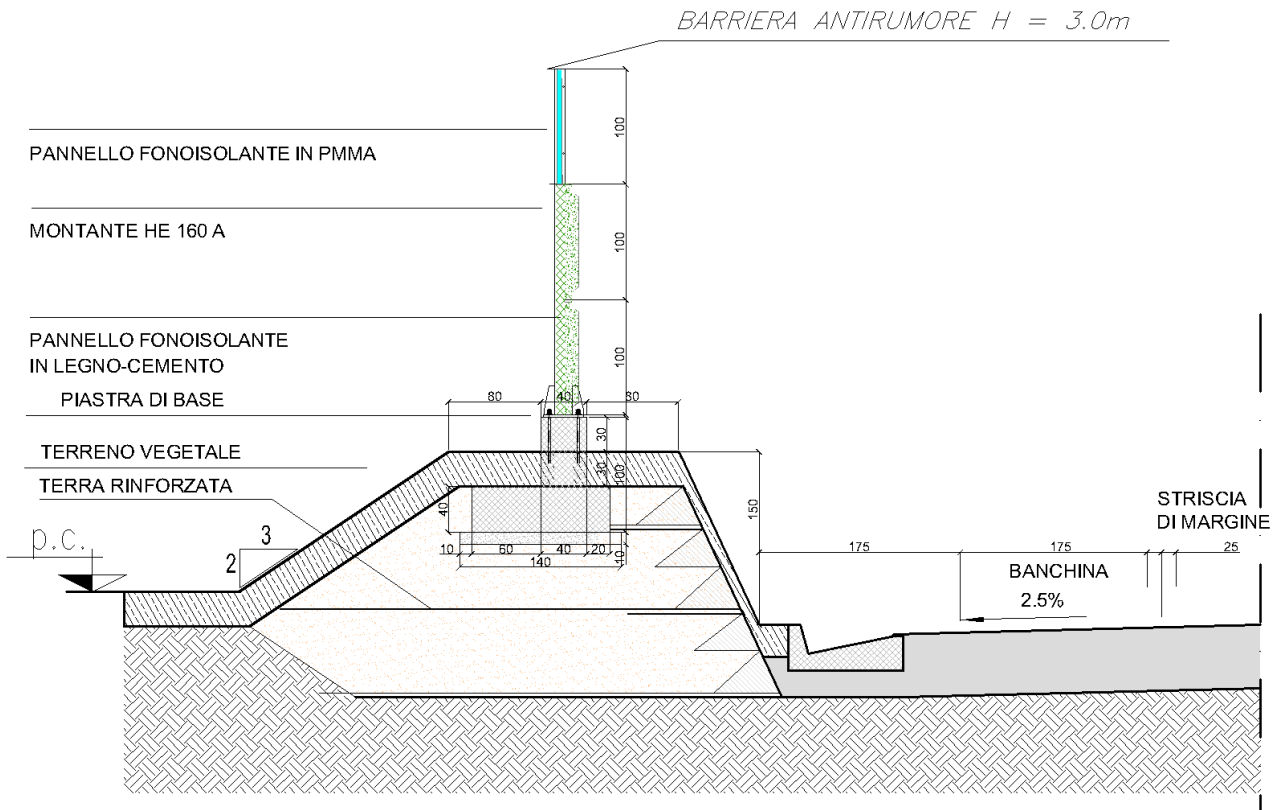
MURO BARRIERA CON FONDAZIONE SU DUNA IN TERRA RINFORZATA
